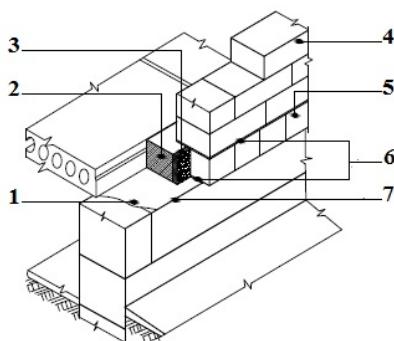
Схема опирания наружной стены на железобетонное основание в местах примыкания плит перекрытий: 1 — гидроизоляция; 2 — монолитный железобетонный пояс; 3 — эффективный утеплитель; 4 — блоки YTONG; 5 — доборные блоки; 6 — цементно-песчаный раствор; 7 — кирпичная кладка
